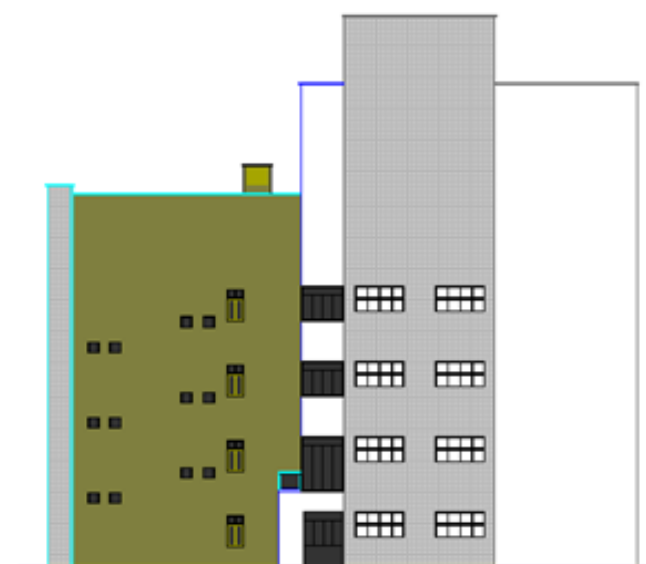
Imagem projeto arquitetônico fachada Oeste em *Autocad*.
